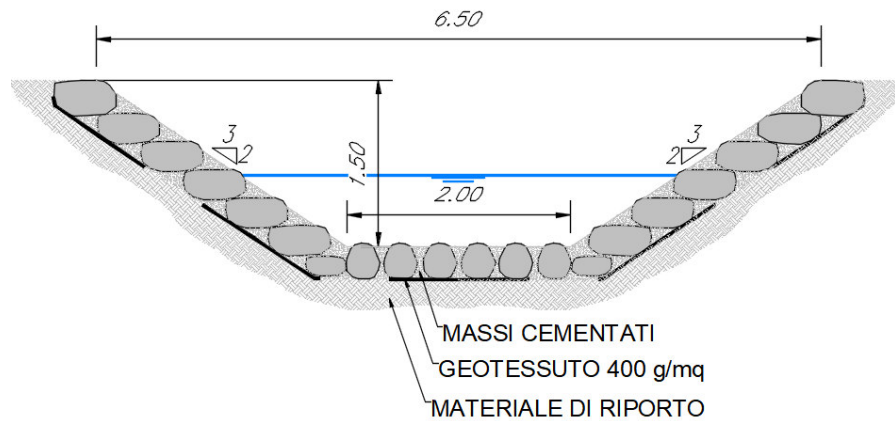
Corso d'acqua IN05_ Sezione tipo sistemazione
